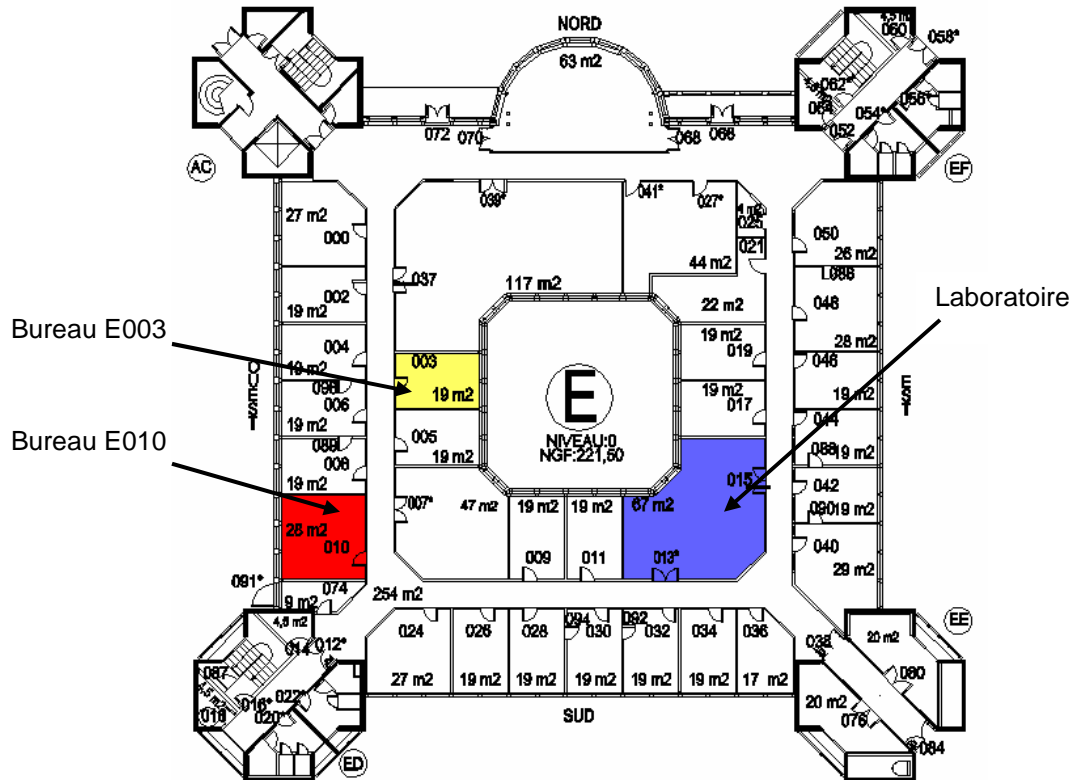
Plan du 1<sup>er</sup> étage du bâtiment E
